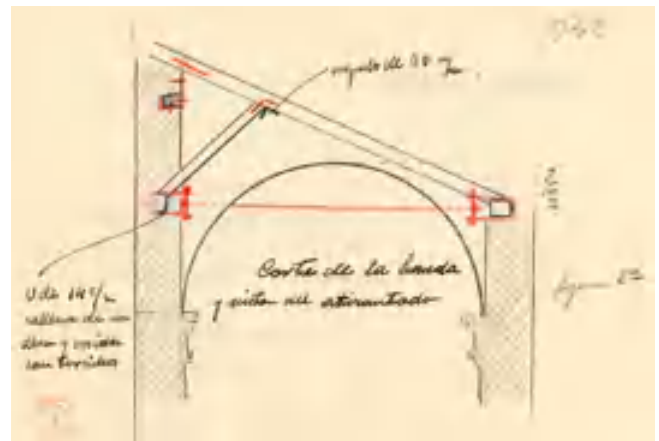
M. Campos, Croquis con corte de la bóveda y atirantado, iglesia de Santa María de los Reales Alcázares, Úbeda, 1932 (APAG, Colección de planos P-008759).
